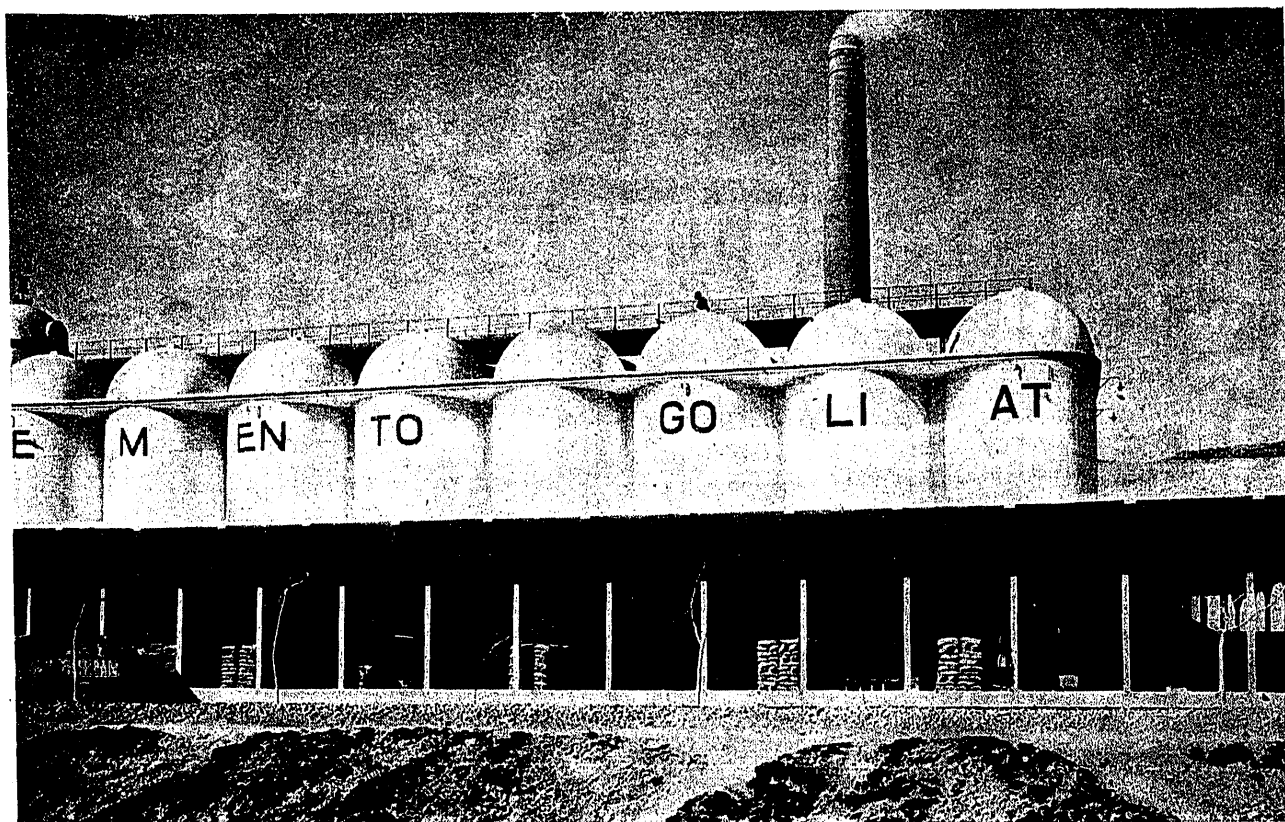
^a — Batería de silos de cemento construida en Málaga en 1924-26, bajo la dirección del Conde de Guadalhorce.
